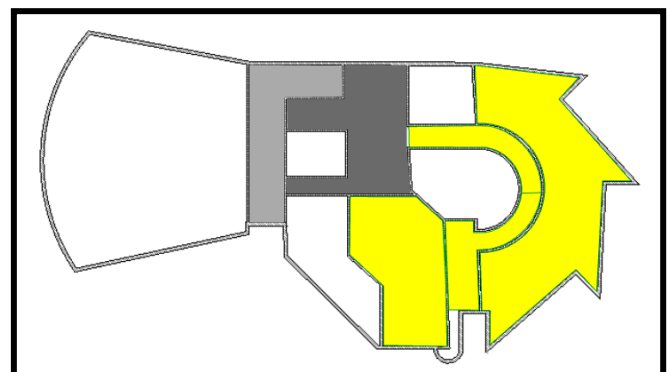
Plan du 1er étage avec éclairage Source ; auteur
